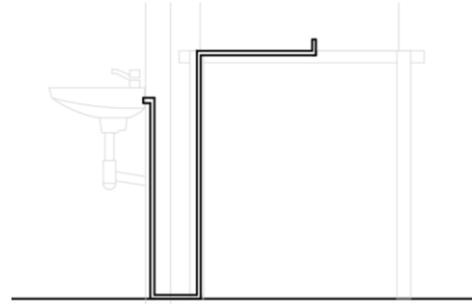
Instalación de tubería hidráulica. Fuente: Elaboración propia.
